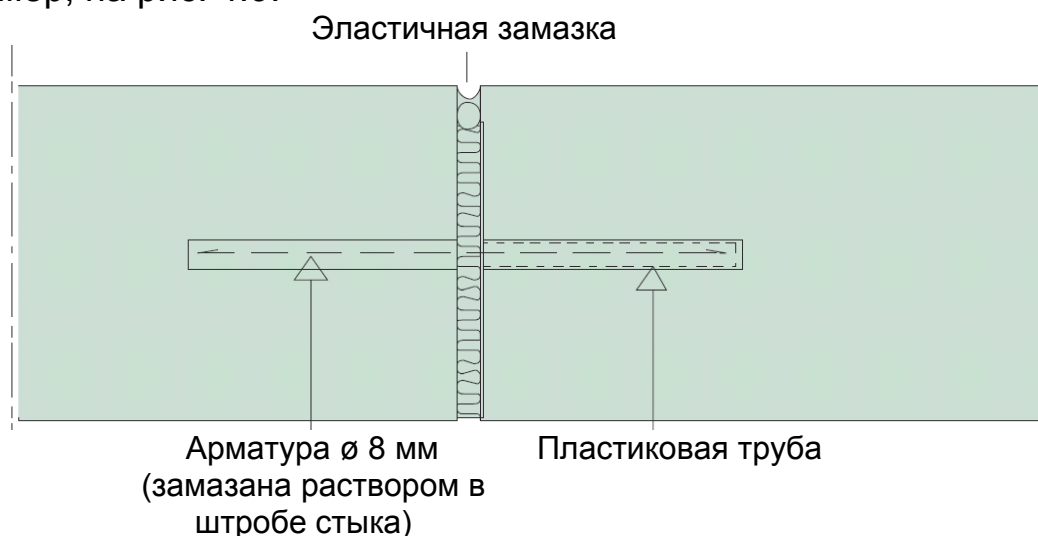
Усадочный шов в стене из газобетонных блоков
